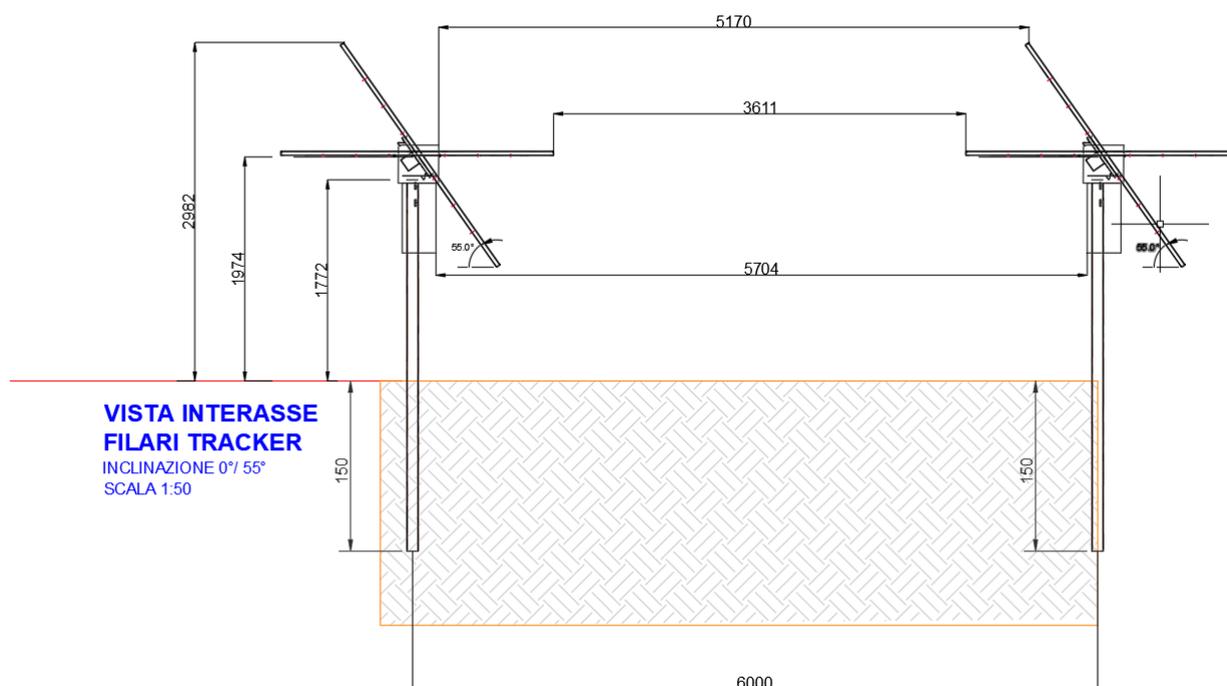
Vista in sezione dei tracker con le quote di progetto
